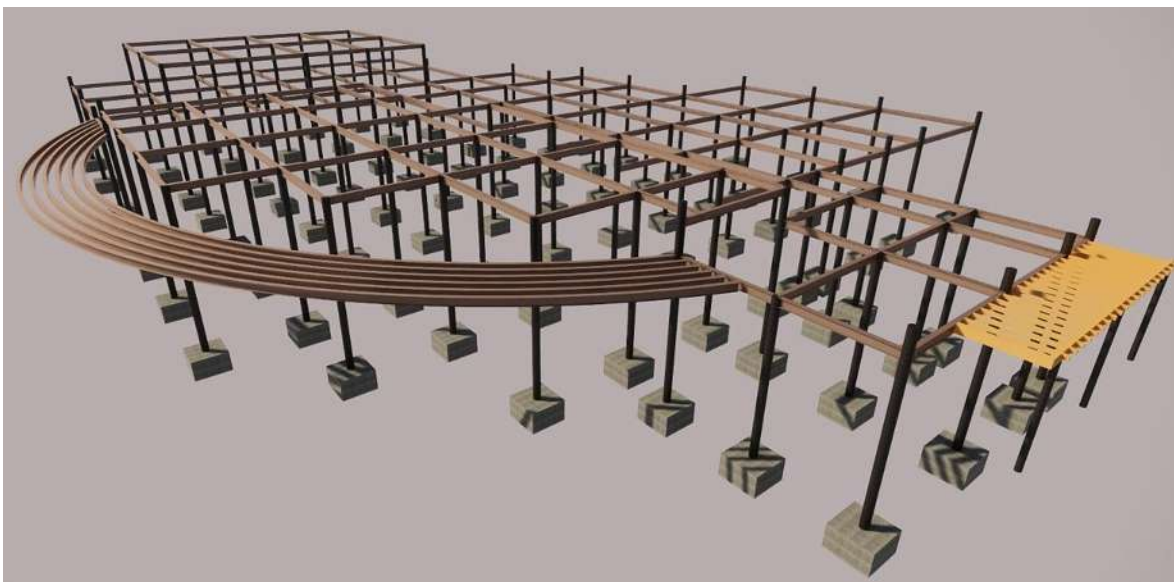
Estructuras de acero con zapatas aisladas empleadas en el sistema de construcción del edificio.
